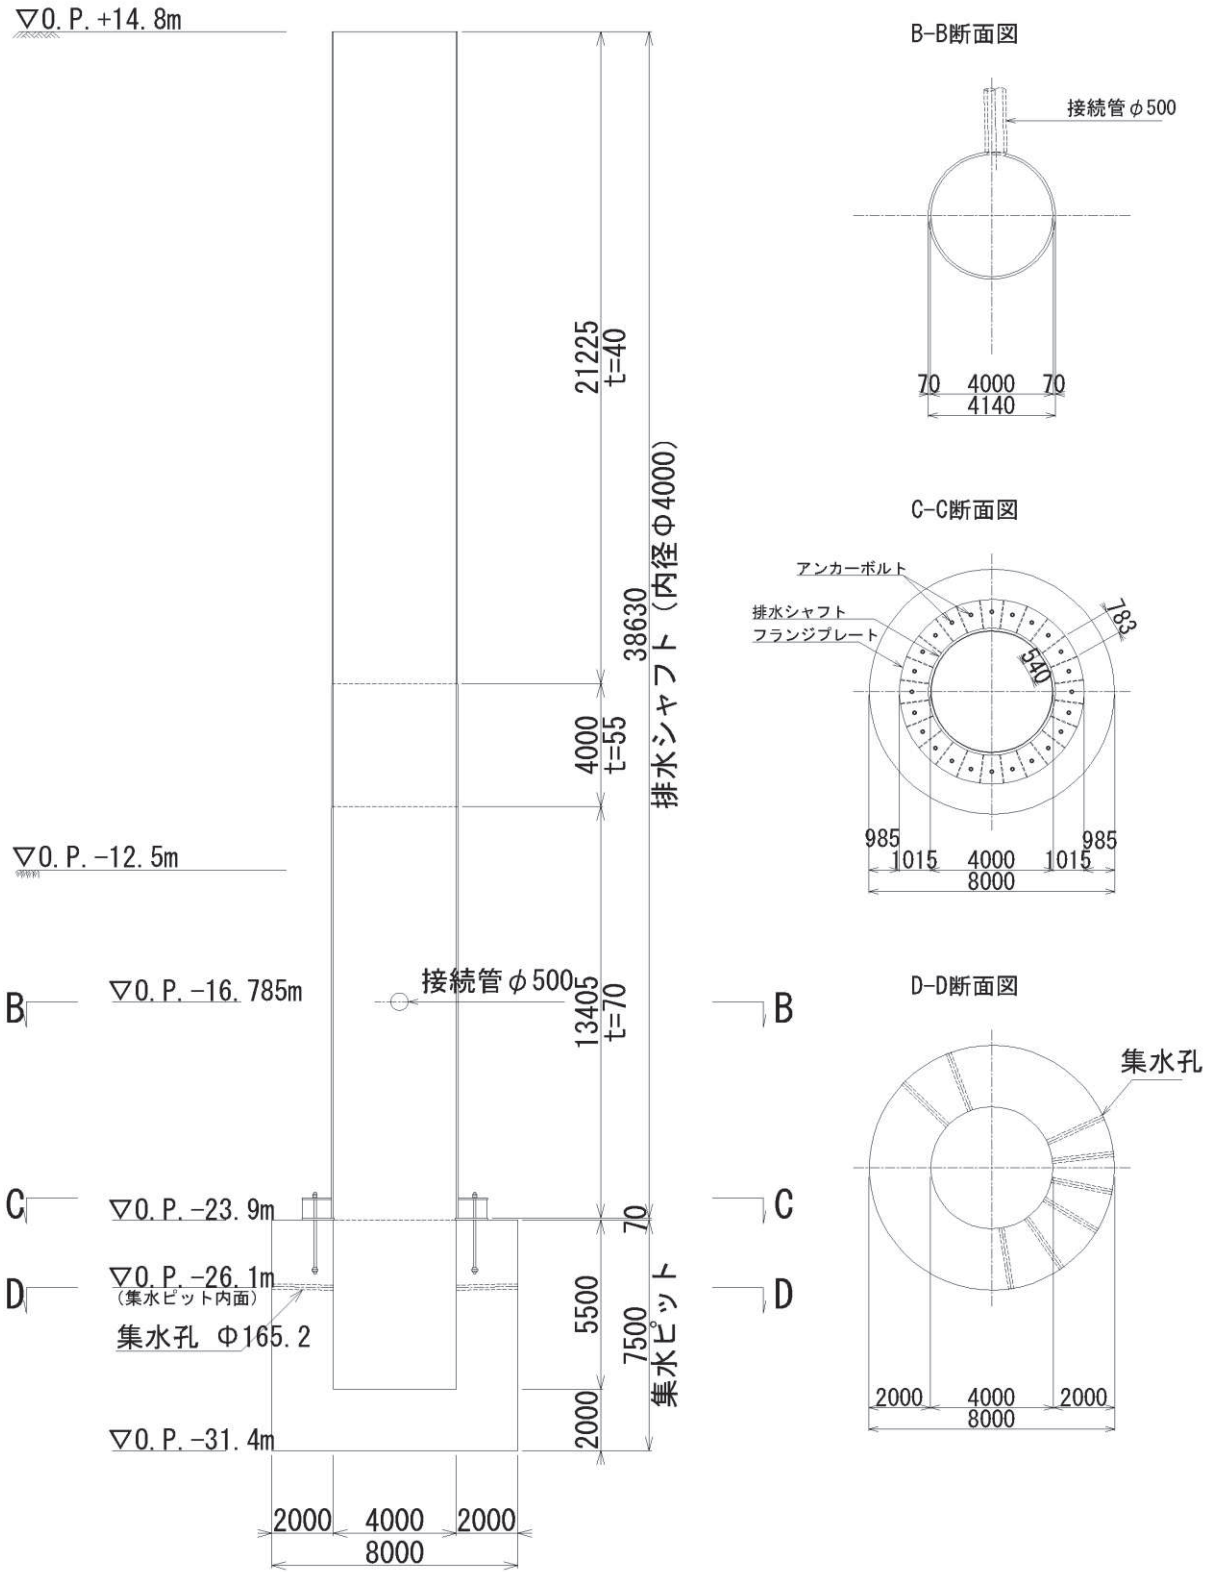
(3) No.3 揚水井戸 構造図 (単位 : mm)
